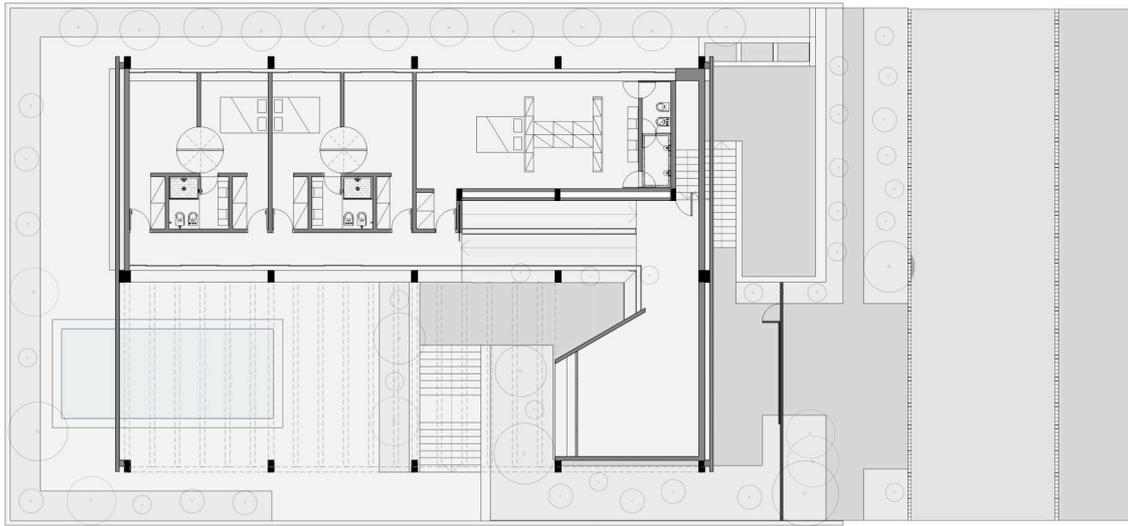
Casa Niclewicz, planta do 2º pavimento.
